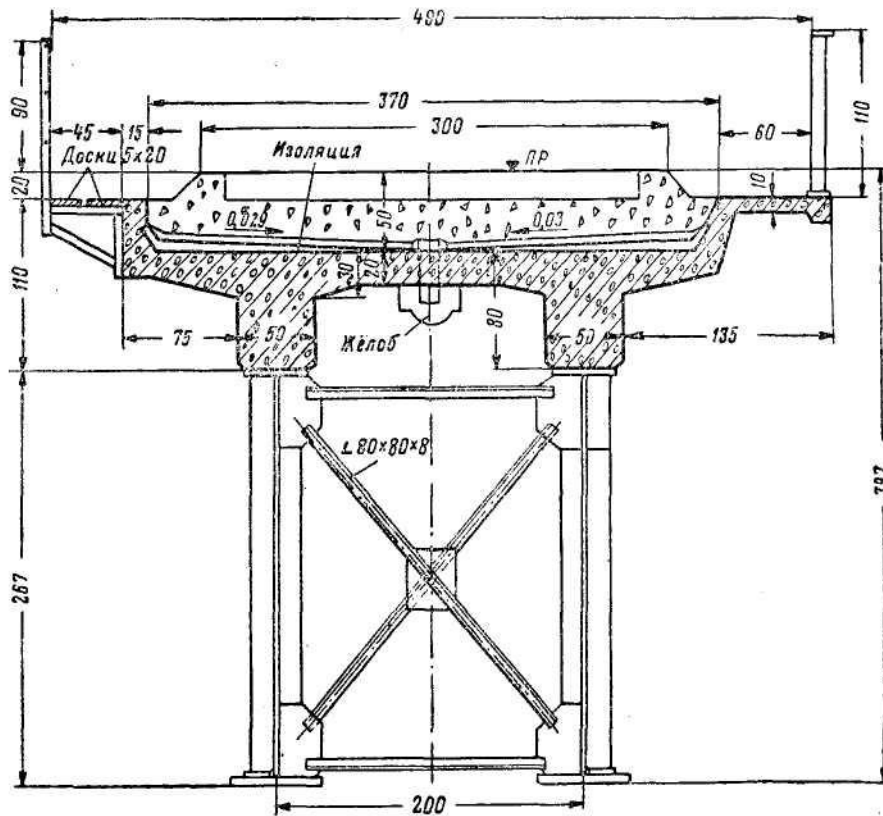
Поперечний розріз прогонної будови із залізобетонною проїжджою частиною
